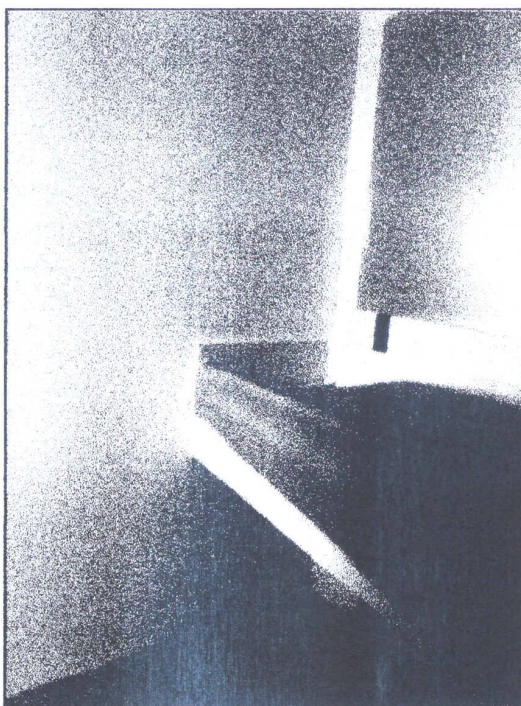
VISTA 02 DO SANITÁRIO DA PISCINA NO PAVIMENTO SUPERIOR
